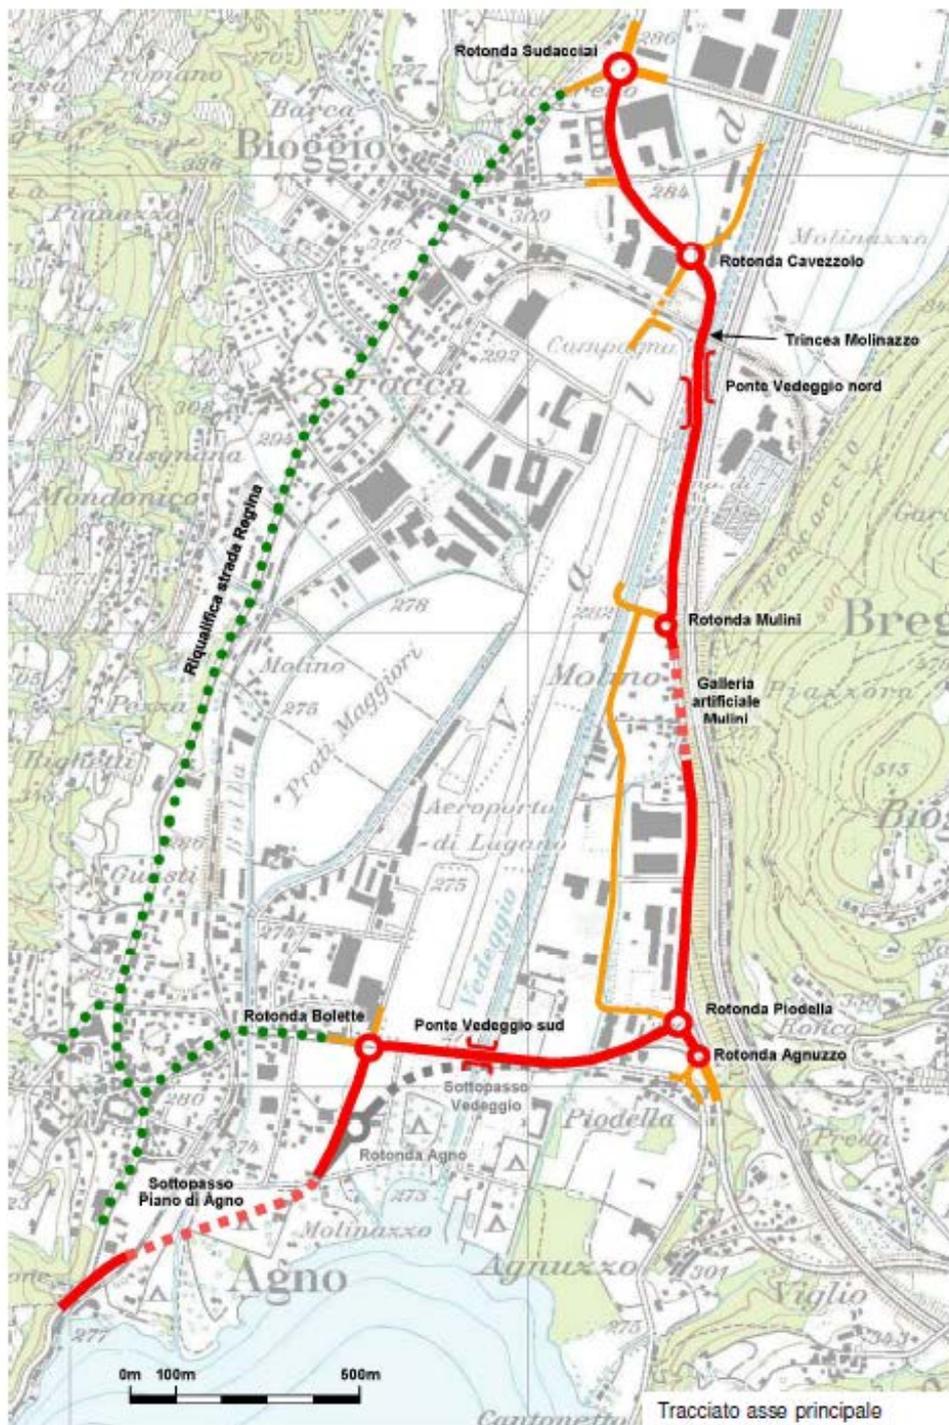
Planimetria della circonvallazione (stato Progetto di massima 2011)
